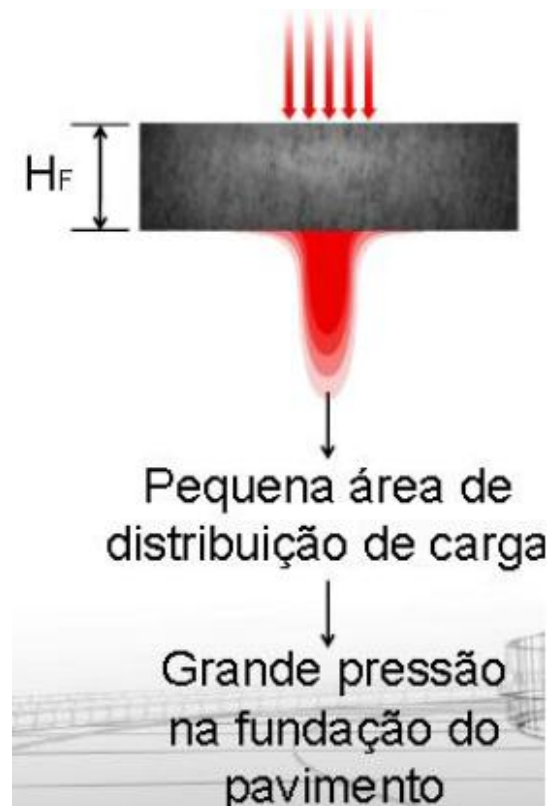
1 – Arranjo Estrutural do Pavimento Flexível
